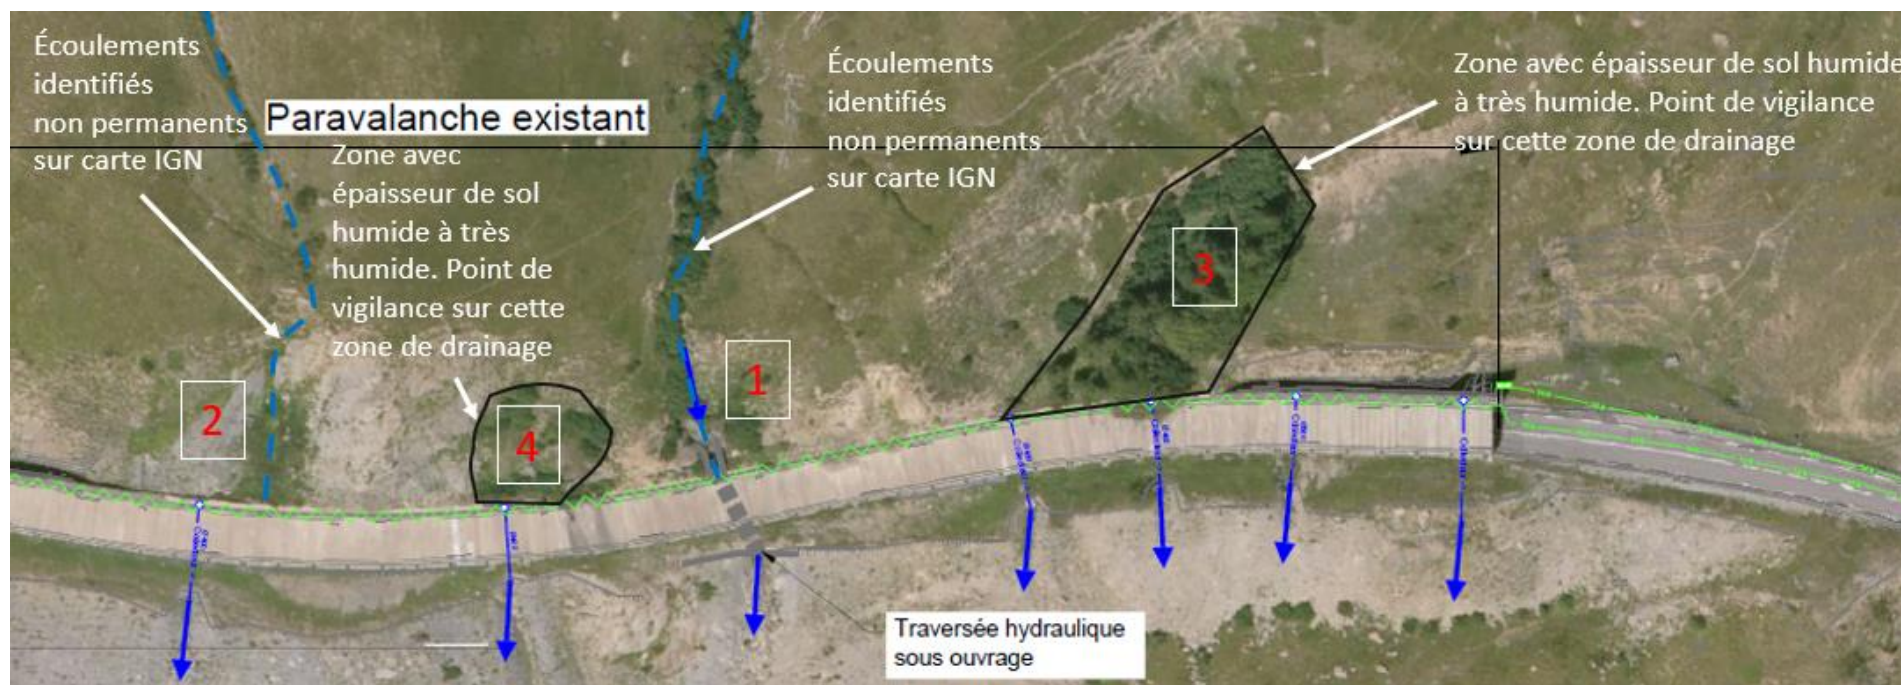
Extrait du plan assainissement des ouvrages existants du paravalanche dir. BRIANCON
